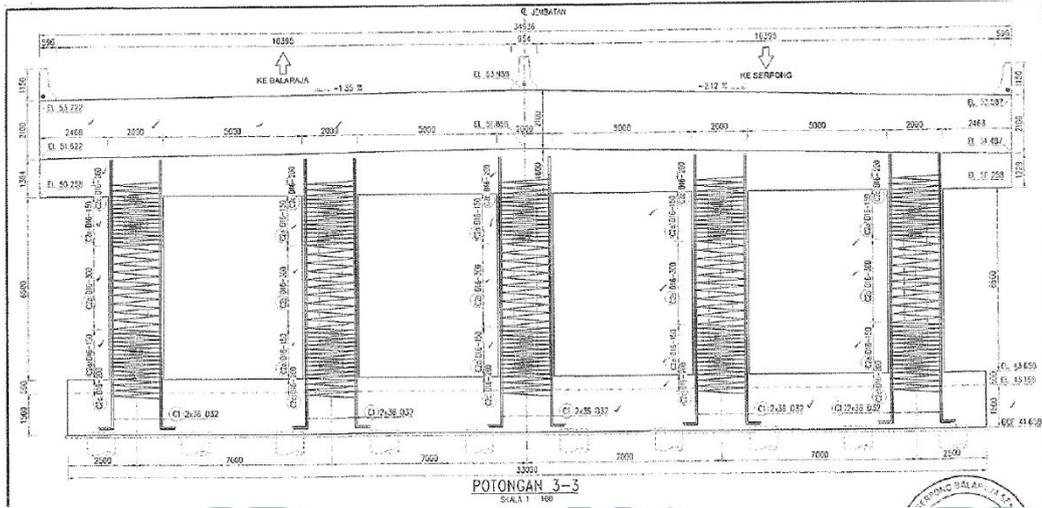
9 Penulangan Kolom Pier P1 STA 8+810
